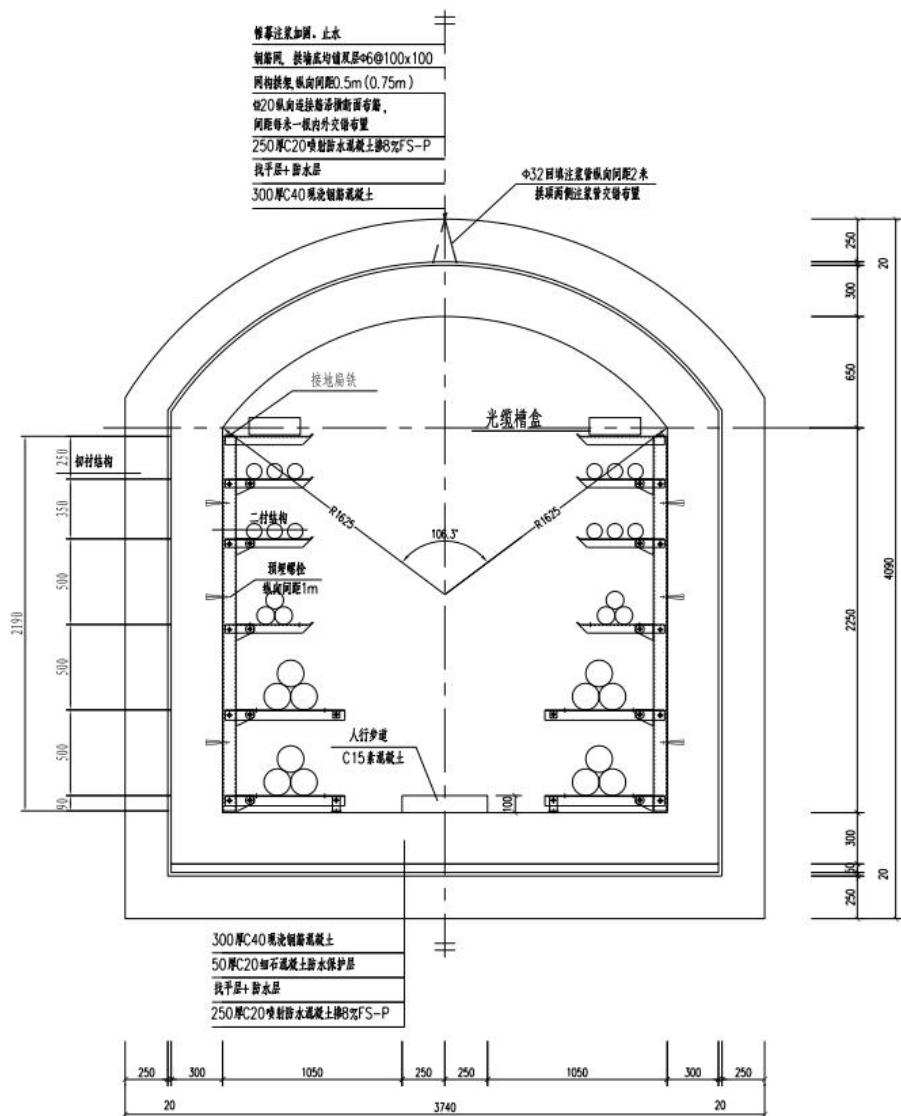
2.6m×2.9m 暗挖单孔隧道断面图
